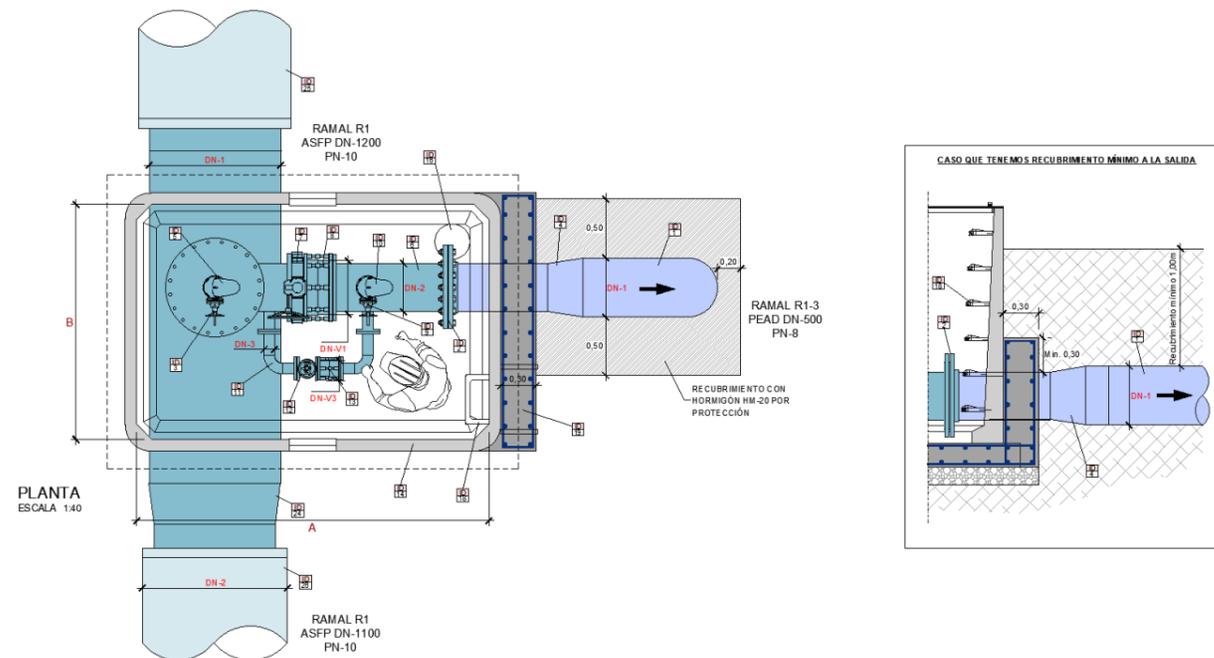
Seccionamiento nº 5 de tipo ASFP. Ramal R1 PQ 1+100.
